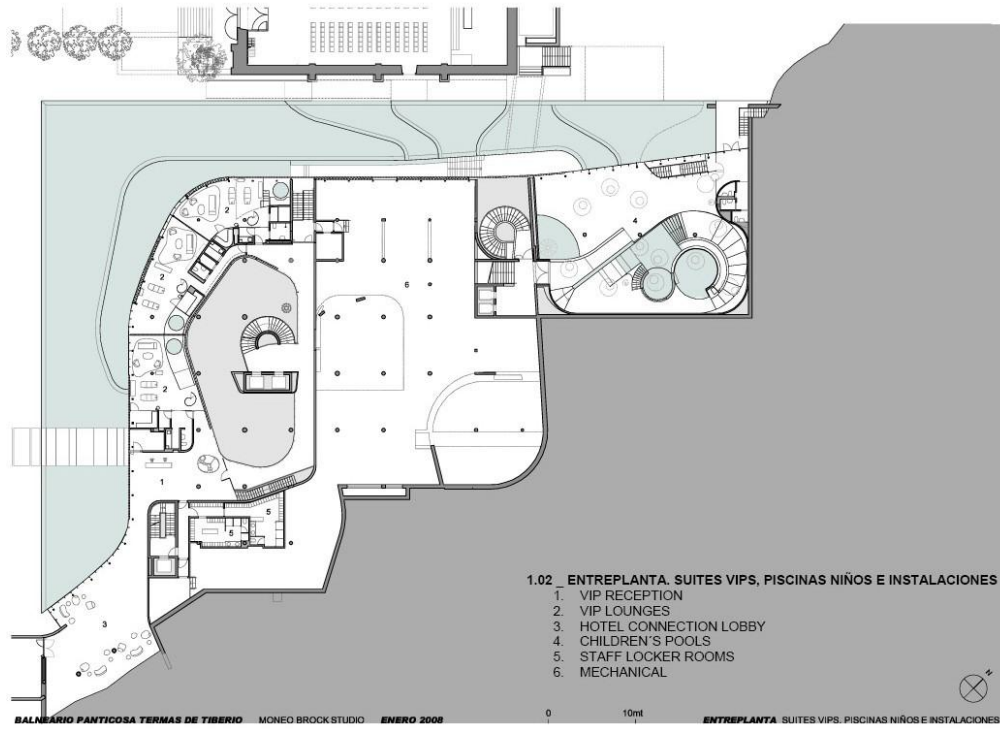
Termas de Tiberio.Vaziyet Planı
